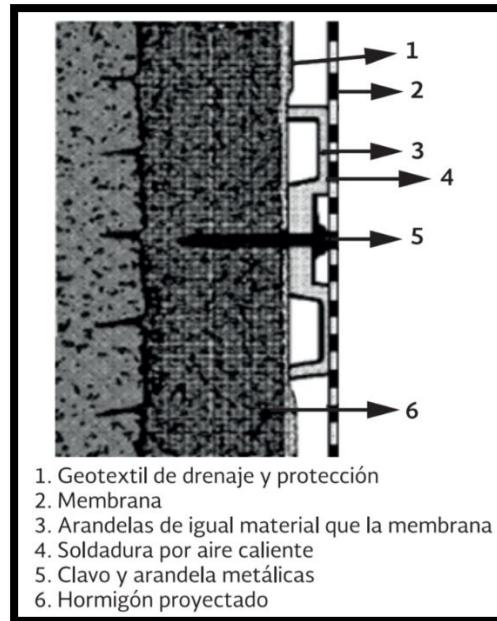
Anclaje del geotextil y soldadura de la membrana
